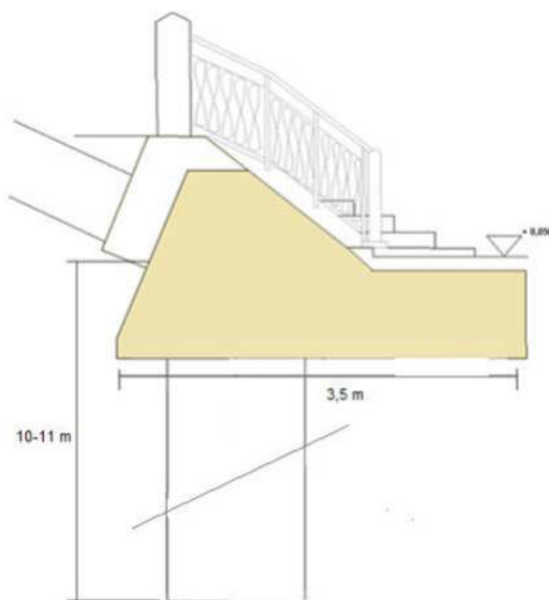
Rappresentazione schematica della fondazione di calcestruzzo tratto da relazione Geo-Controlli
